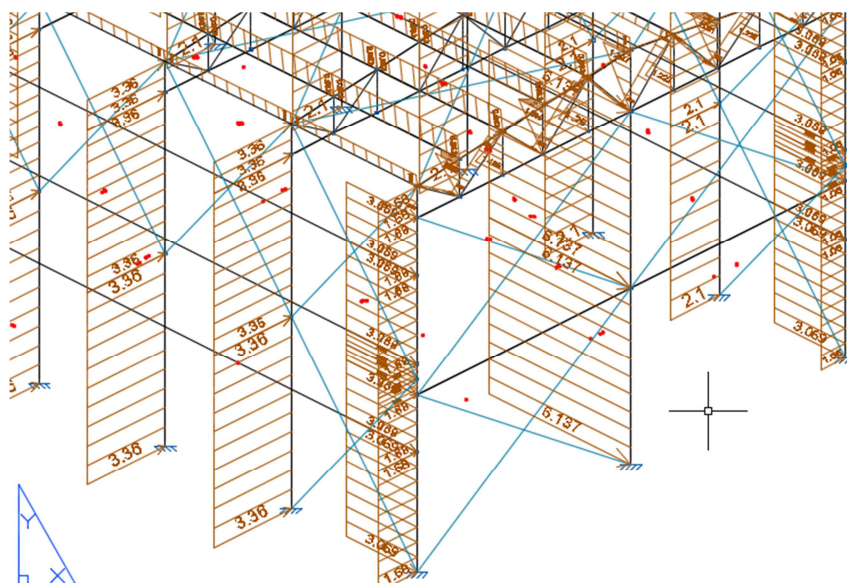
Carga repartida del viento en la fachada ABC (frontal) sobre pilares Hipotesis 1
